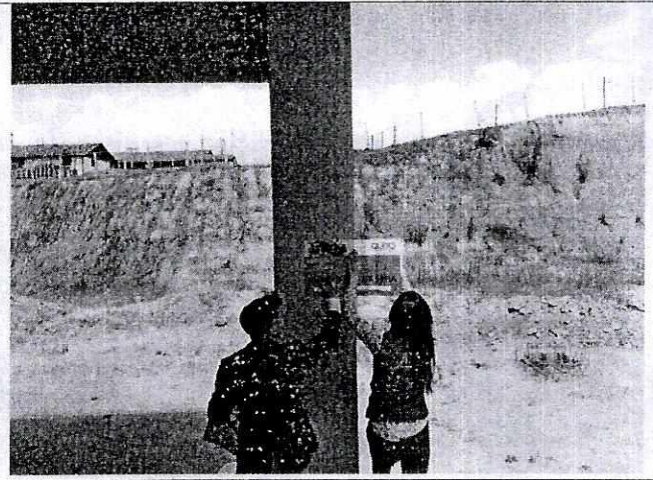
Colocación de sello de suspensión en el acceso – ubicación posterior de la edificación.
